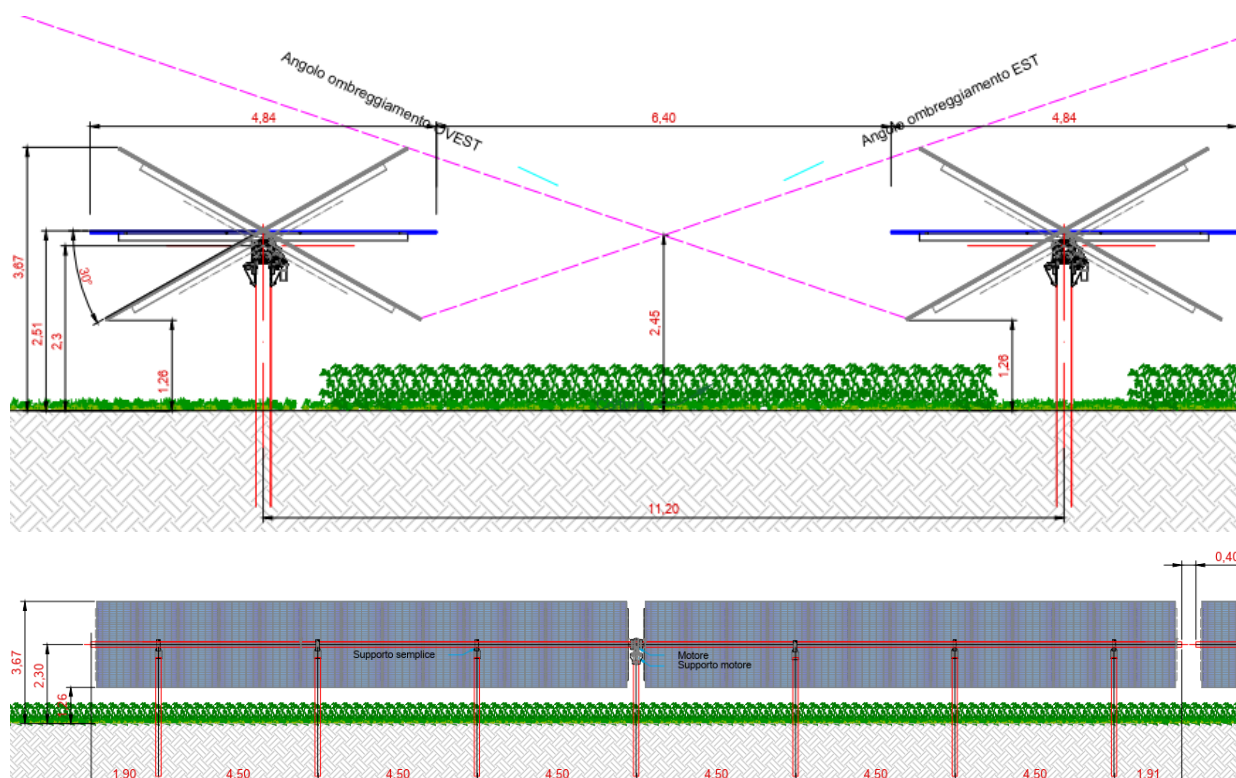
Sezione trasversale tipologica struttura Tracker – Soluzione 30°
